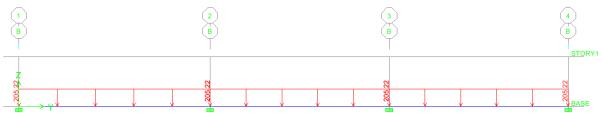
Schéma statique de la nervure ELS (Sens transversale).
